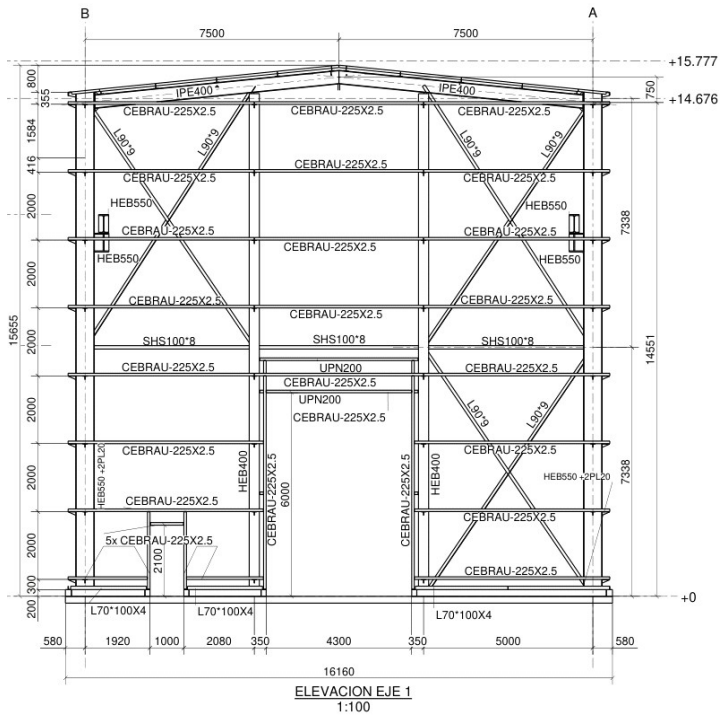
Elevación eje 1 Nave Metálica grupo 1.
